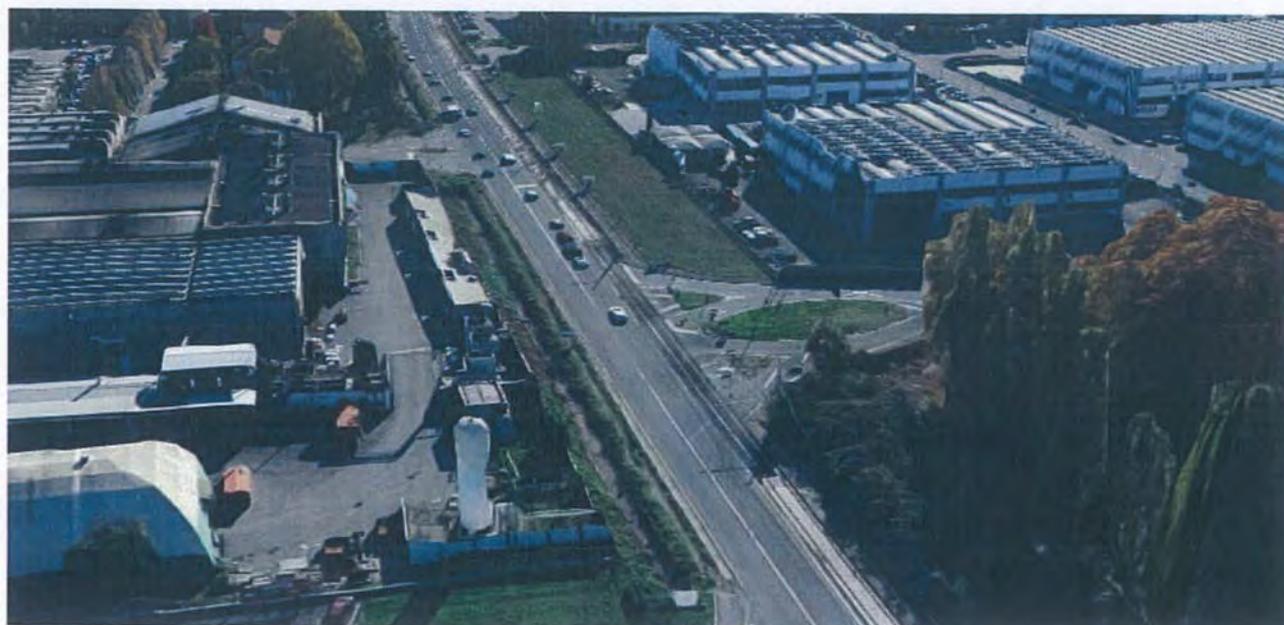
Intersezione 4 – Via Beccaria / via dei Giovi
